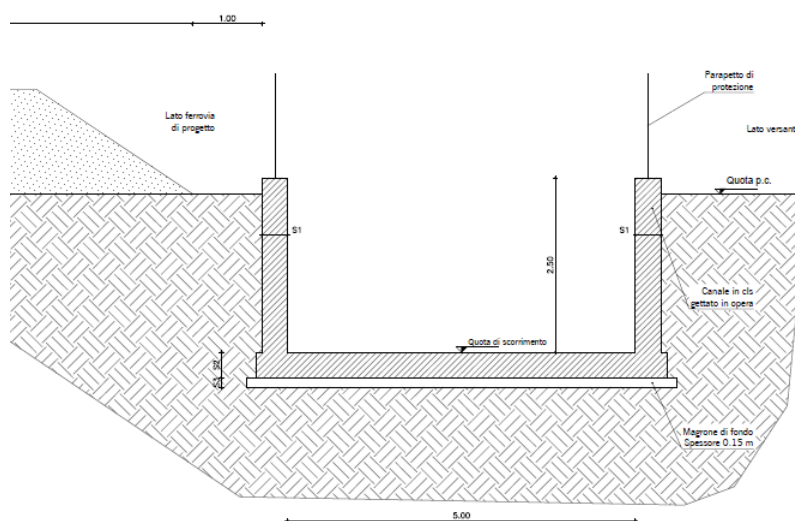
Sezione tipo a "U" Vallone Buffardo.
